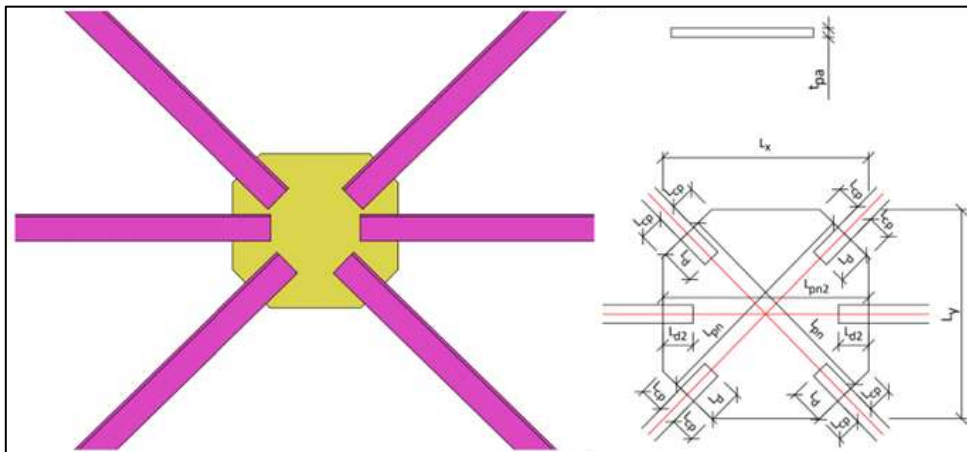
Conexión a corte Gusset Plate Central – Columna (Perfiles: alma llena)
